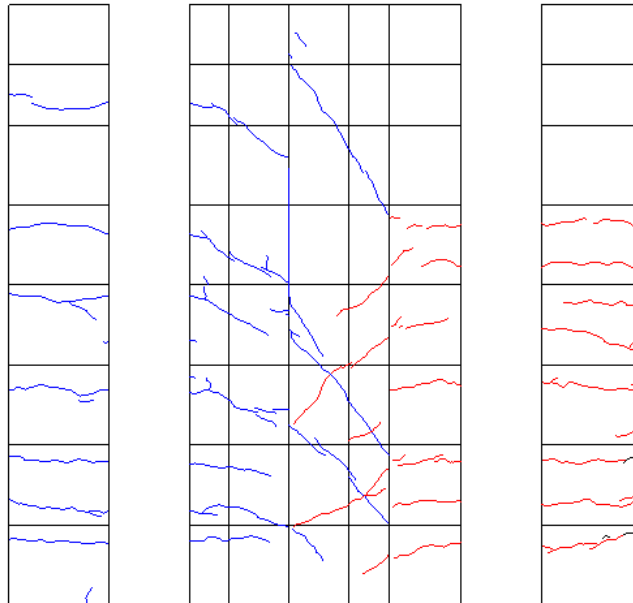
R=1/200 ひび割れ図
